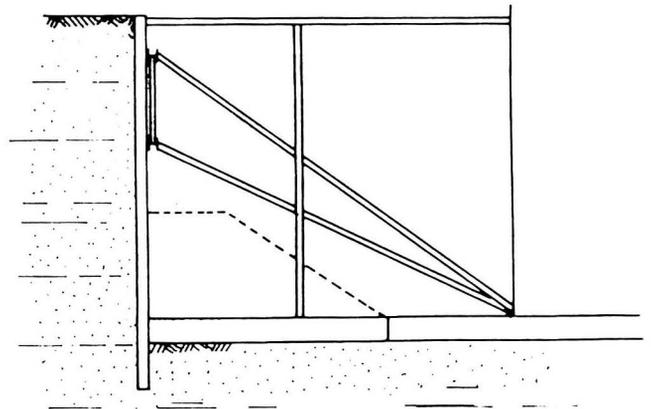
EXCAVACION CON APUNTALAMIENTO MEDIANTE CODALES CONTRA LA LOSA DE FONDO Y BANQUETA PERIMETRAL
